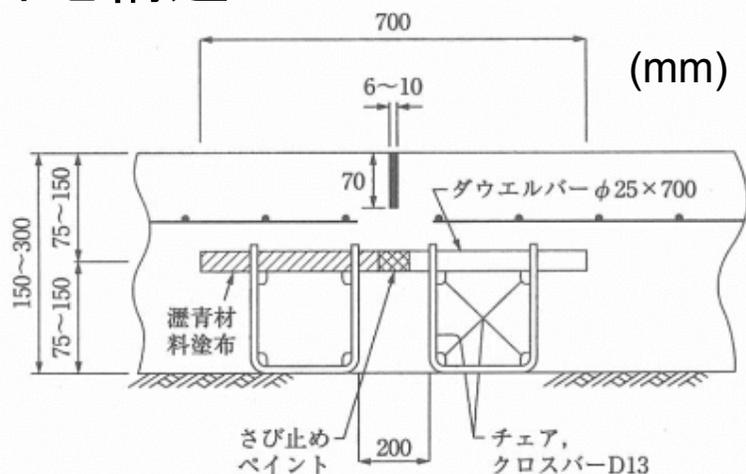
一般的な横収縮・ダミー目地の構造例
